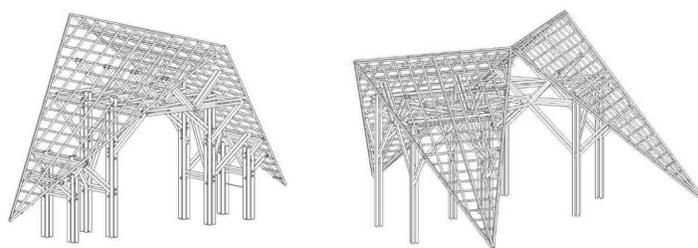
Izquierda: Detalle de la estructura del pórtico exterior del edificio socio administrativo. Derecha: Detalle de la estructura del pórtico interior del edificio socio administrativo. Fuente: autores, 2018.
